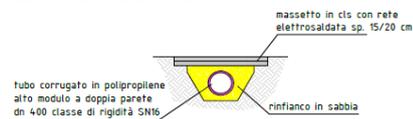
Tipologia di attraversamento stradale e cavalcafosso in progetto
